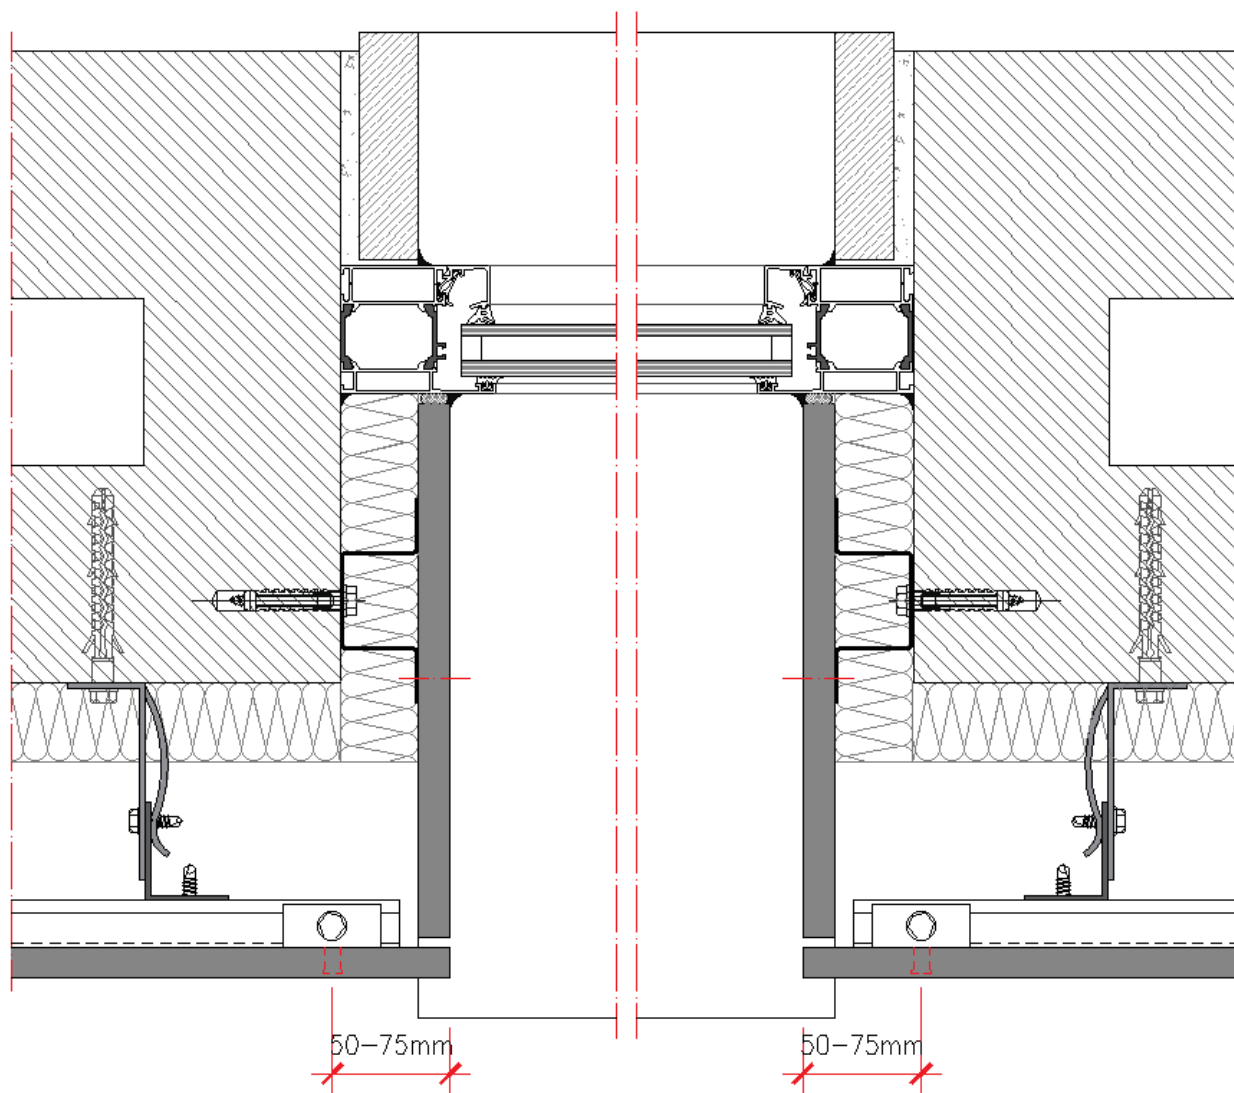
Pormenor do vão de janela, corte horizontal
